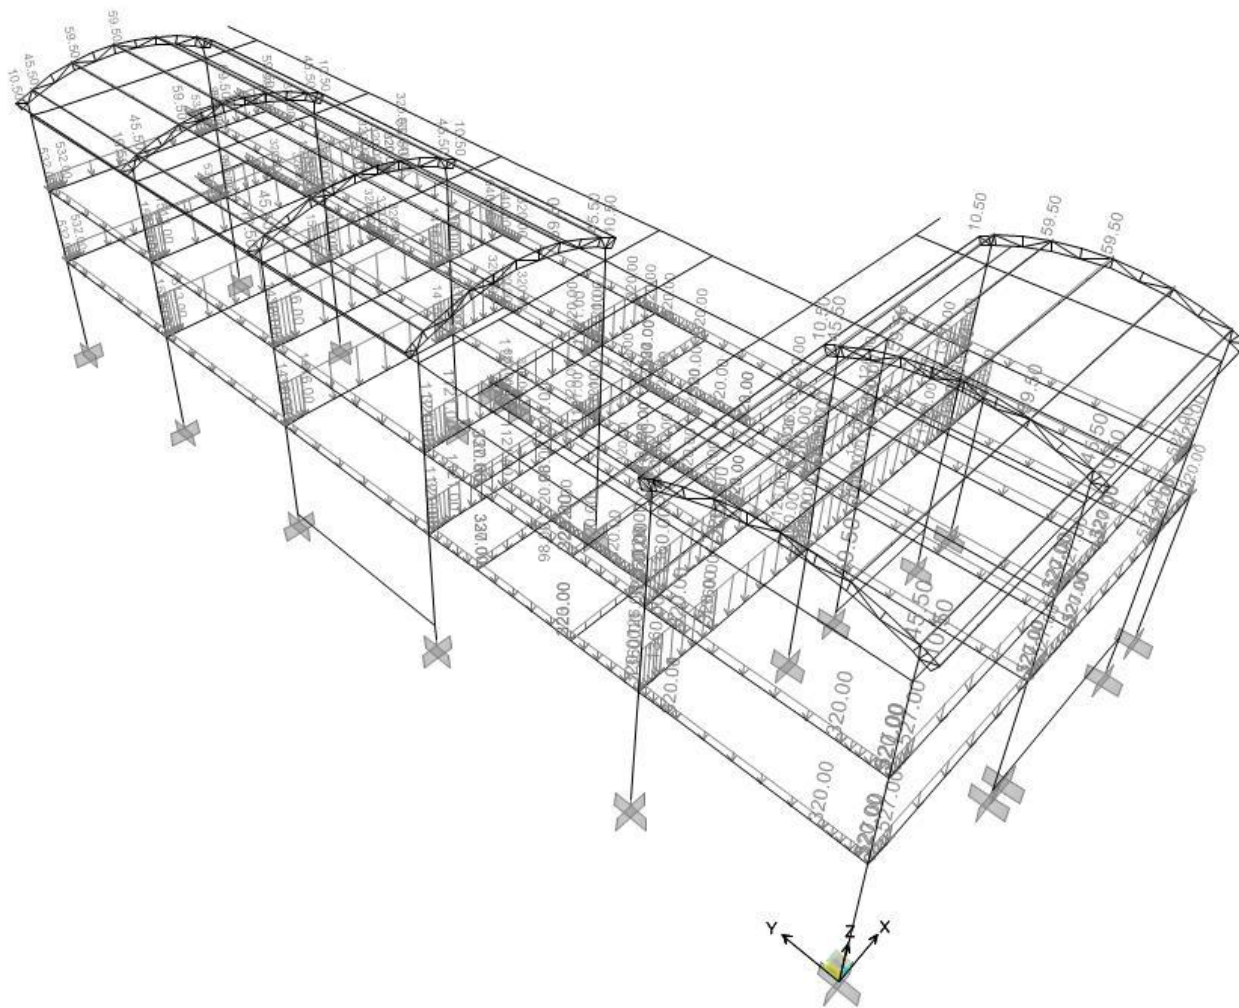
Carga muerta sobre vigas de entreso N+3.00m y N+6.00m
